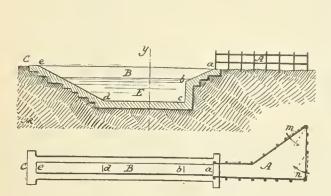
Coupe longitudinale et plan de bassin pour l'immersion des baufs.
